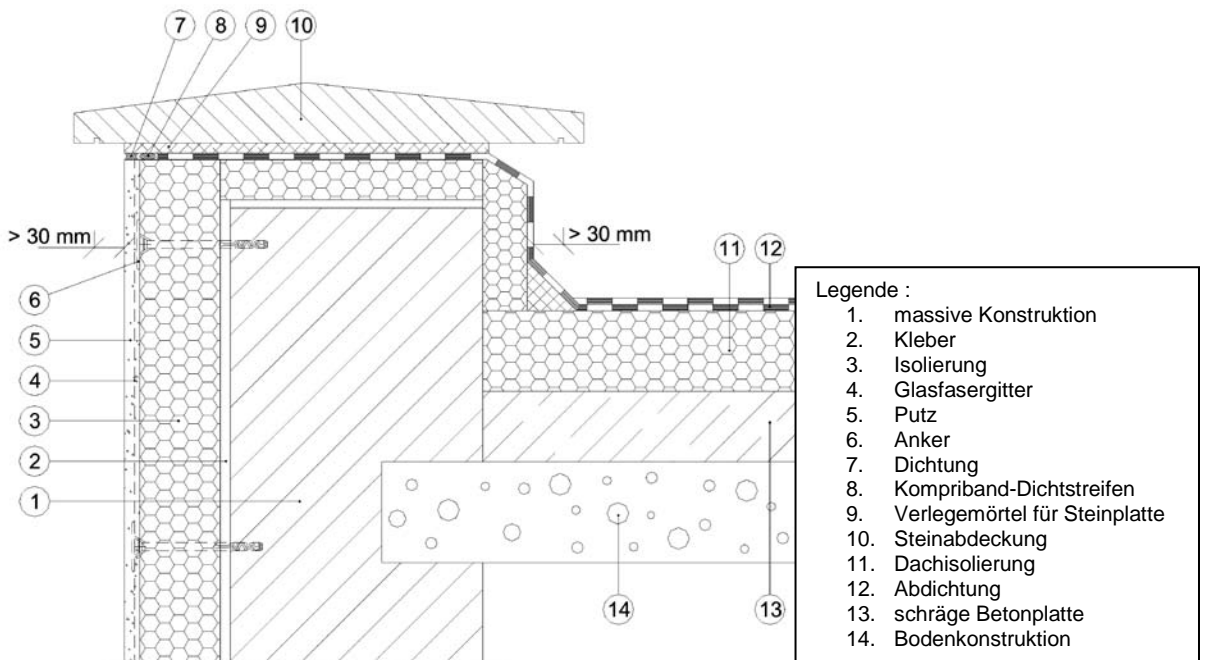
Bauliche Durchbildung einer Flachdacheinfassung mit Steinabdeckung
